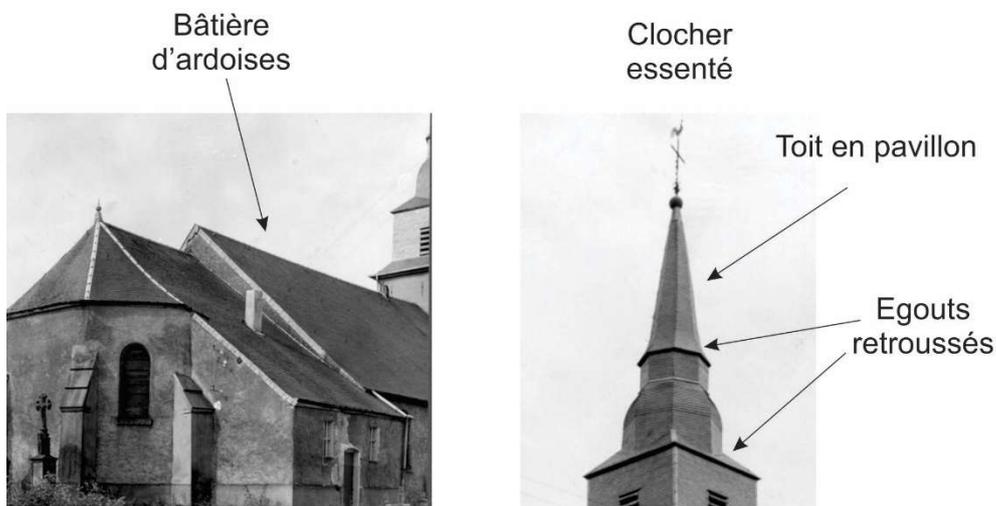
Toiture et clocher de l'église de Villers, essenté et sur égouts retroussés
